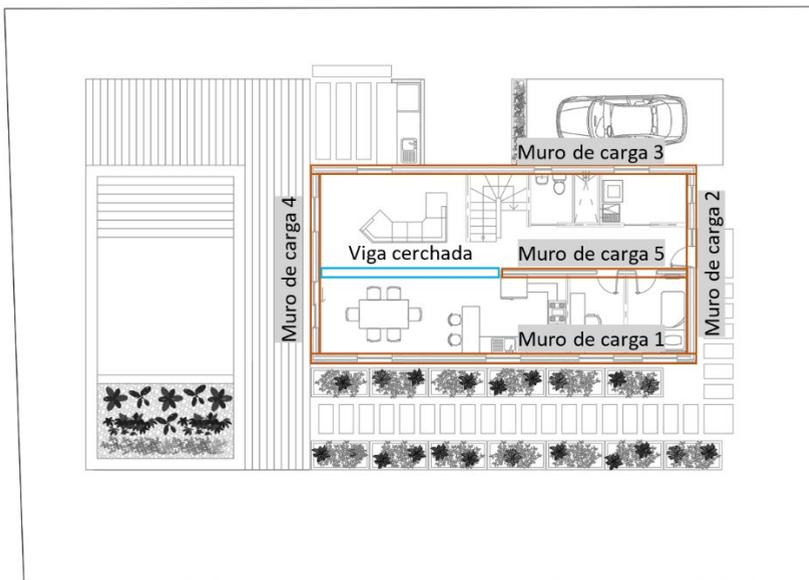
Ubicación muros de carga PB. Elaboración propia
